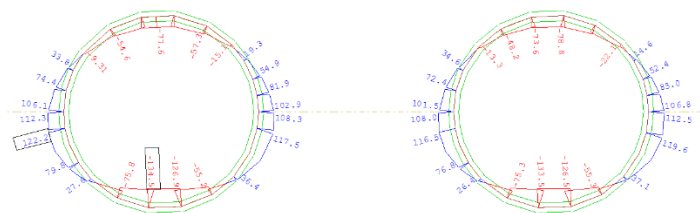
Эпюра моментов, возникающая в конструкции железобетонной обделки на стадии завершеного строительства тоннеля в разрезе С-С
